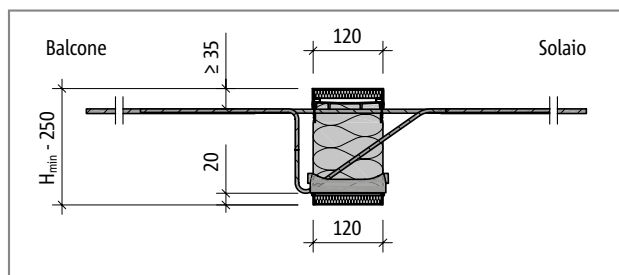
Schöck Isokorb® tipo da KXT15 a KXT40, REI120: sezione dell'elemento
